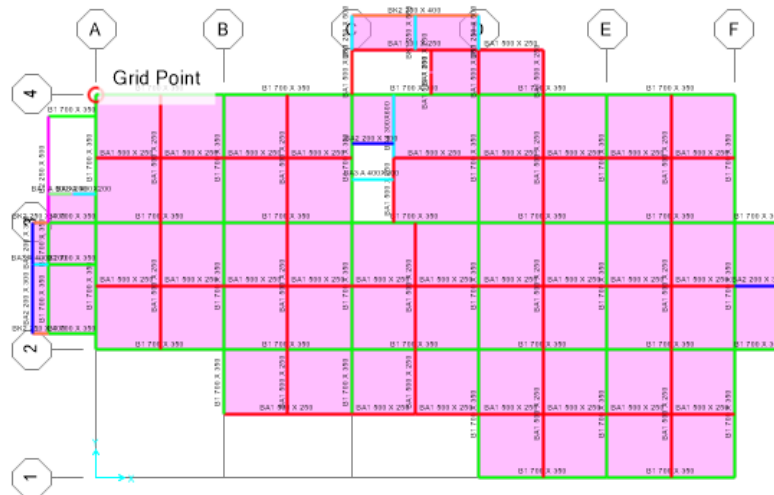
17 Permodelan Balok dan Pelat Lantai 2
